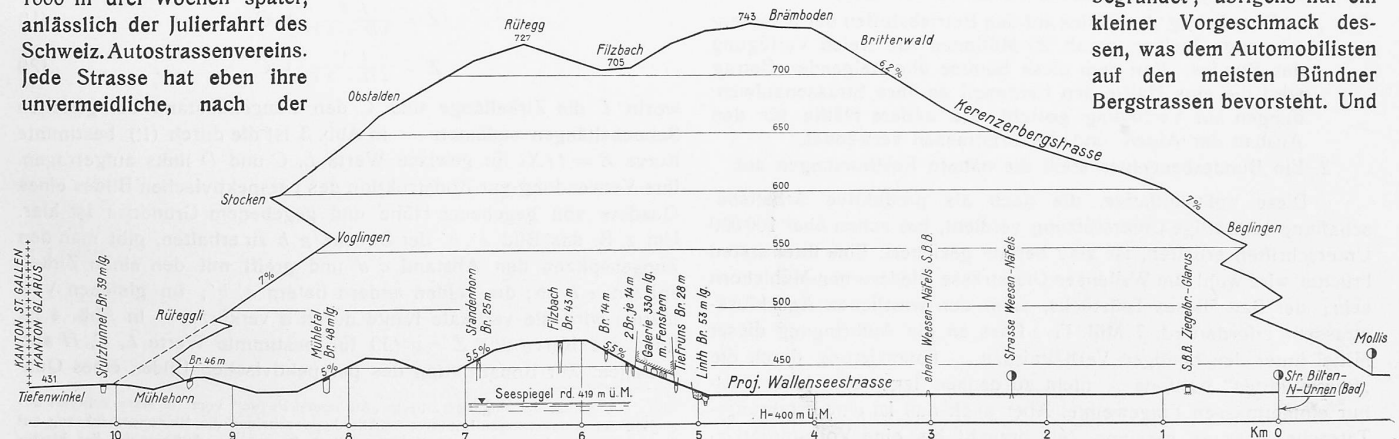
Vergleichendes Längenprofil (zehnfach überhöht) der Kerenzerbergstrasse und der projektierten Wallensee-Uferstrasse, Teilstrecke Mühlehorn-Niederurnen.
